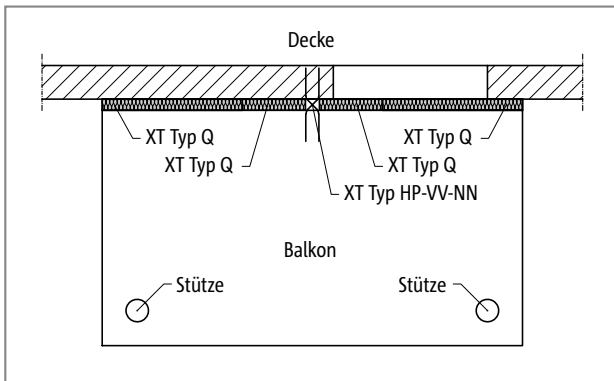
Schöck Isokorb® XT Typ HP: Balkon mit Stützenlagerung
